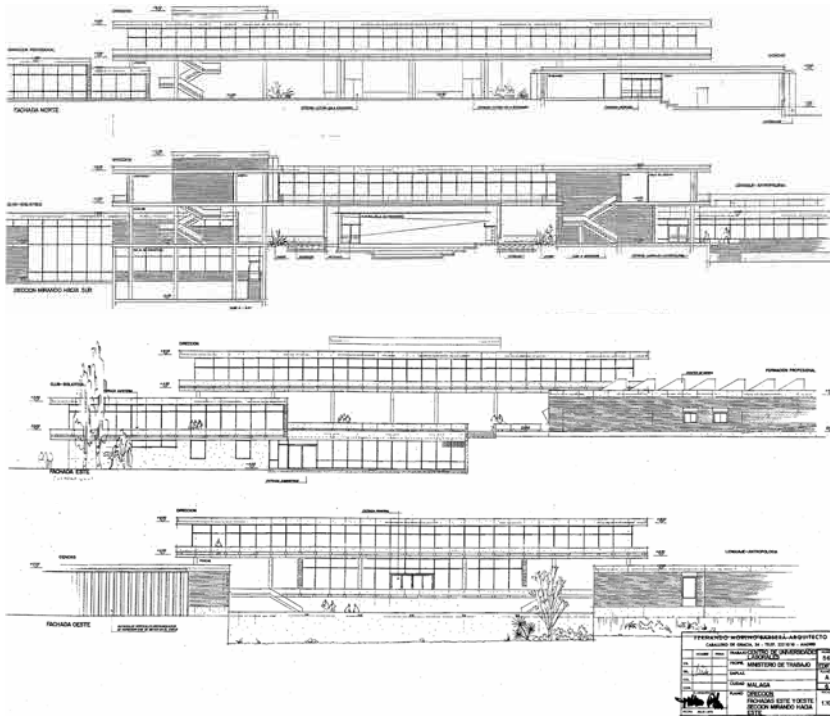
, Fig. 12, Fig. 13 y Fig. 14 Zona docente. De arriba a abajo: alzado de la fachada Norte, sección por el patio del edificio de dirección mirando hacia el Sur, alzado de la fachada Este (a la izquierda en la imagen, el edificio del club-biblioteca según la versión previa a la definitiva) y alzado de la fachada Oeste o principal.
